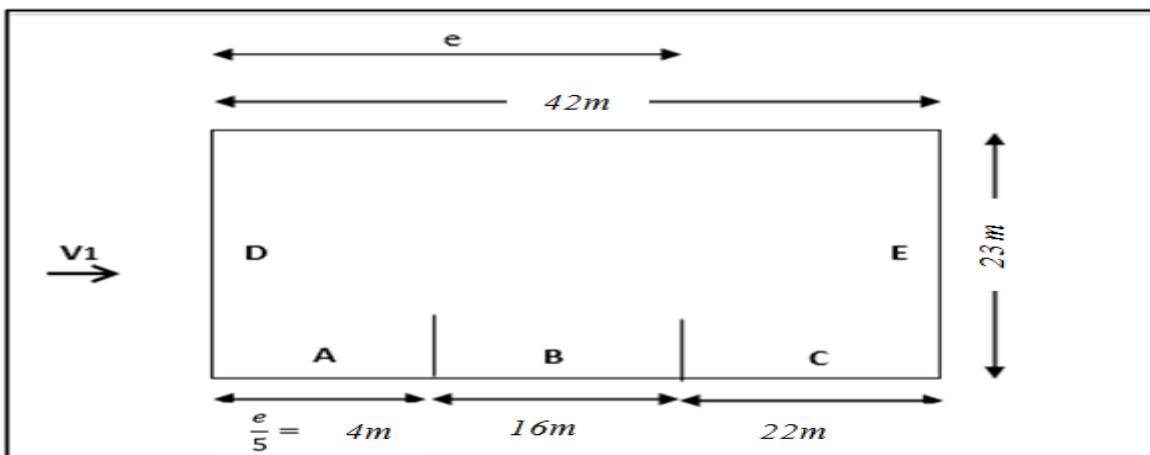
Vue en plan des zones de pression sur les parois verticales sens V1.
